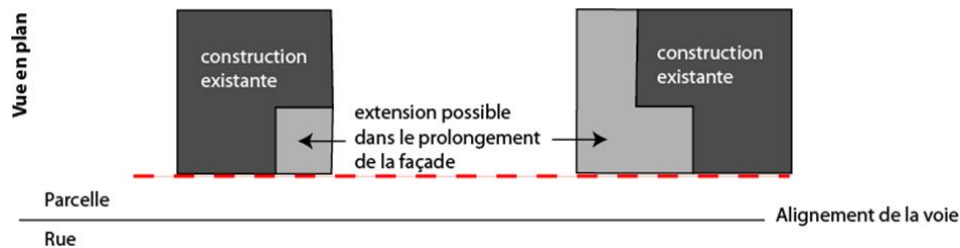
Implantation dans le prolongement de la façade pour les extensions des constructions en zone Ub
